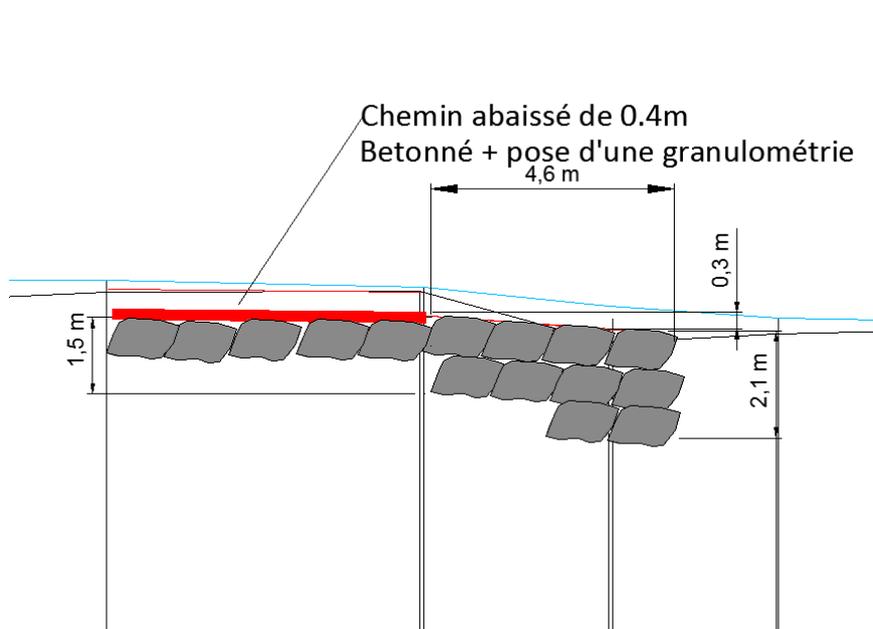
profil en long de la rampe au Gué terratus+ abaissement du chemin
